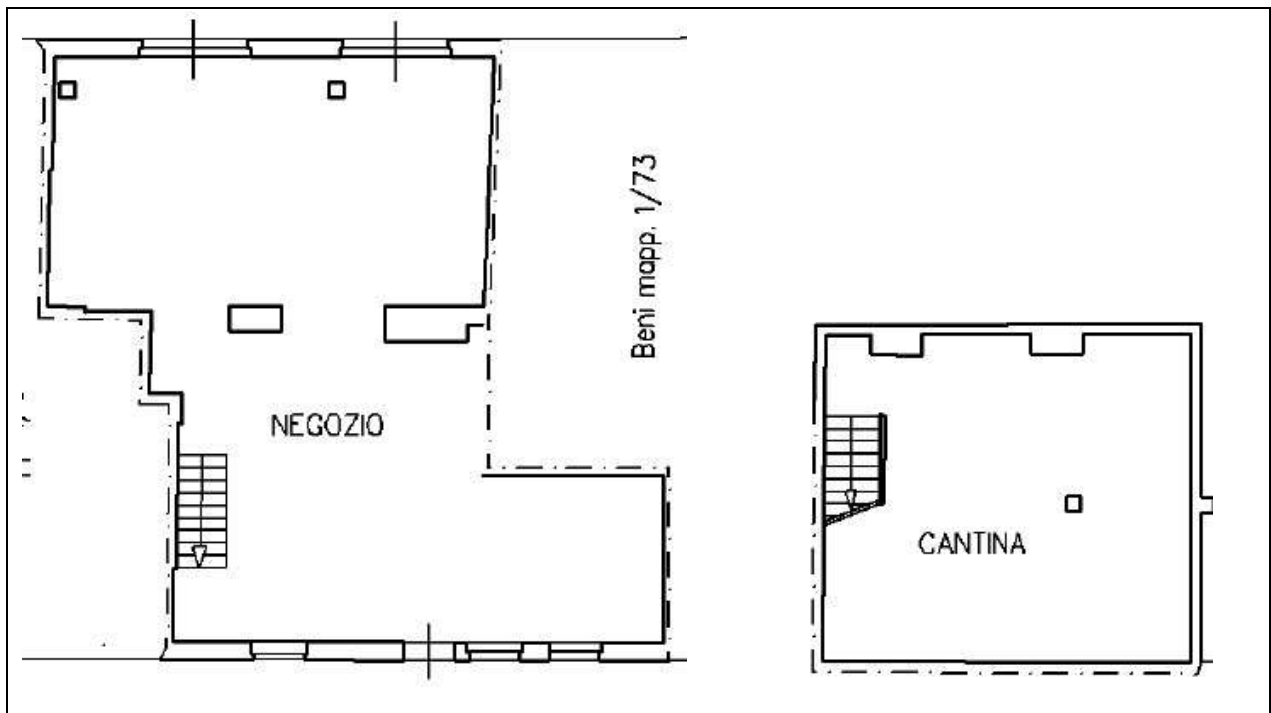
Planimetria catastale - Sez. NCT fg.90 Part. 1 sub.72
